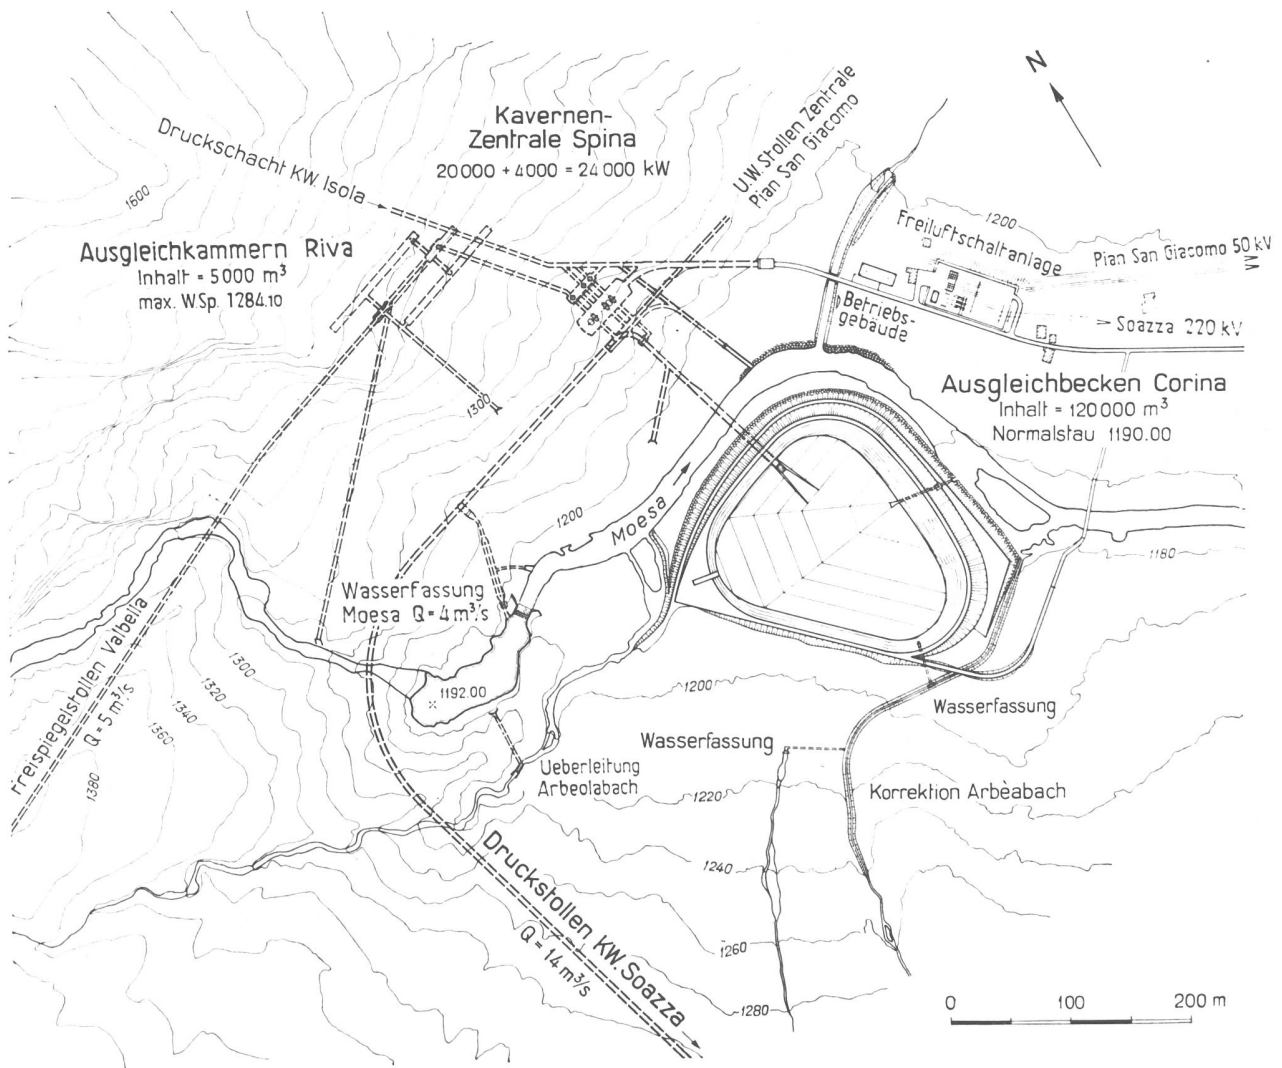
Lageplan der Kraftwerkanlagen Spina/Corina im Gebiet von Pian San Giacomo
